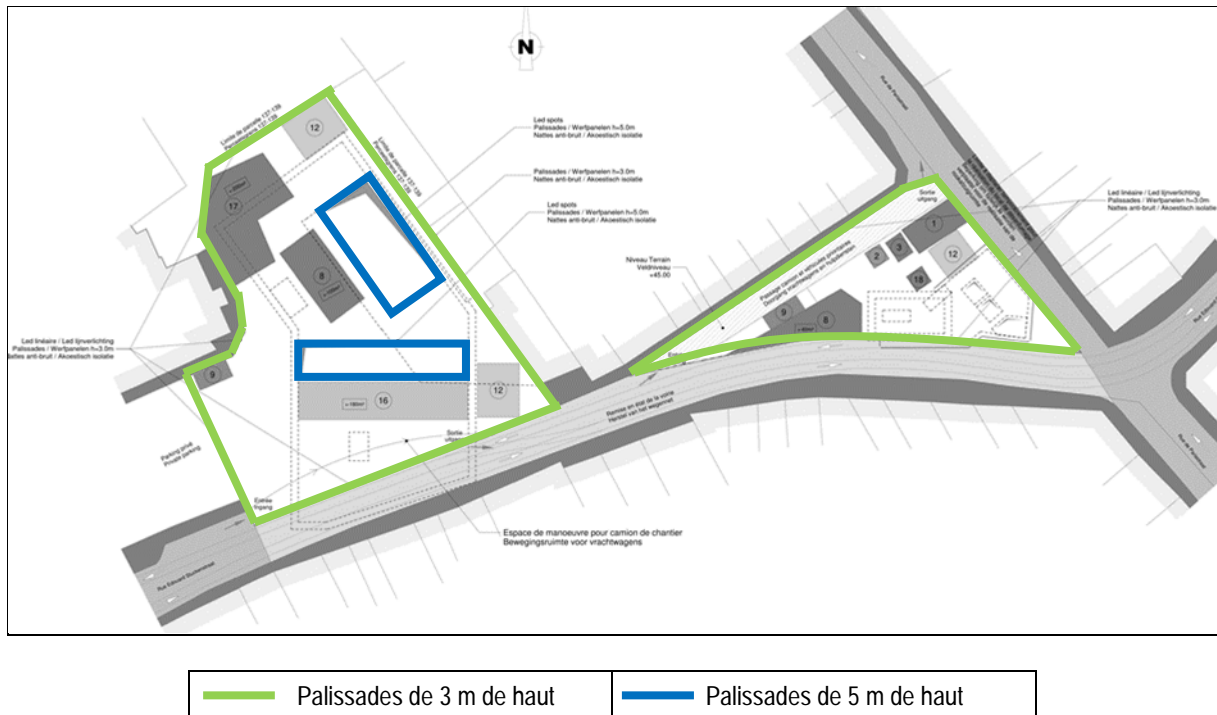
Installations de chantier station Paix – Phase B (BMN 2020)
